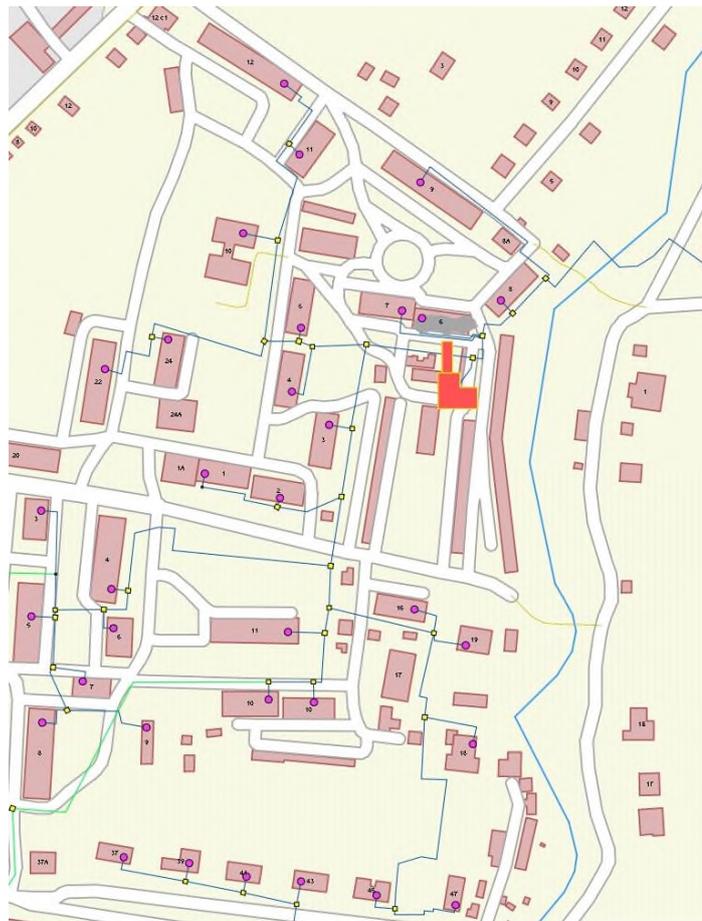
Схема теплоснабжения от котельной № 1/4
